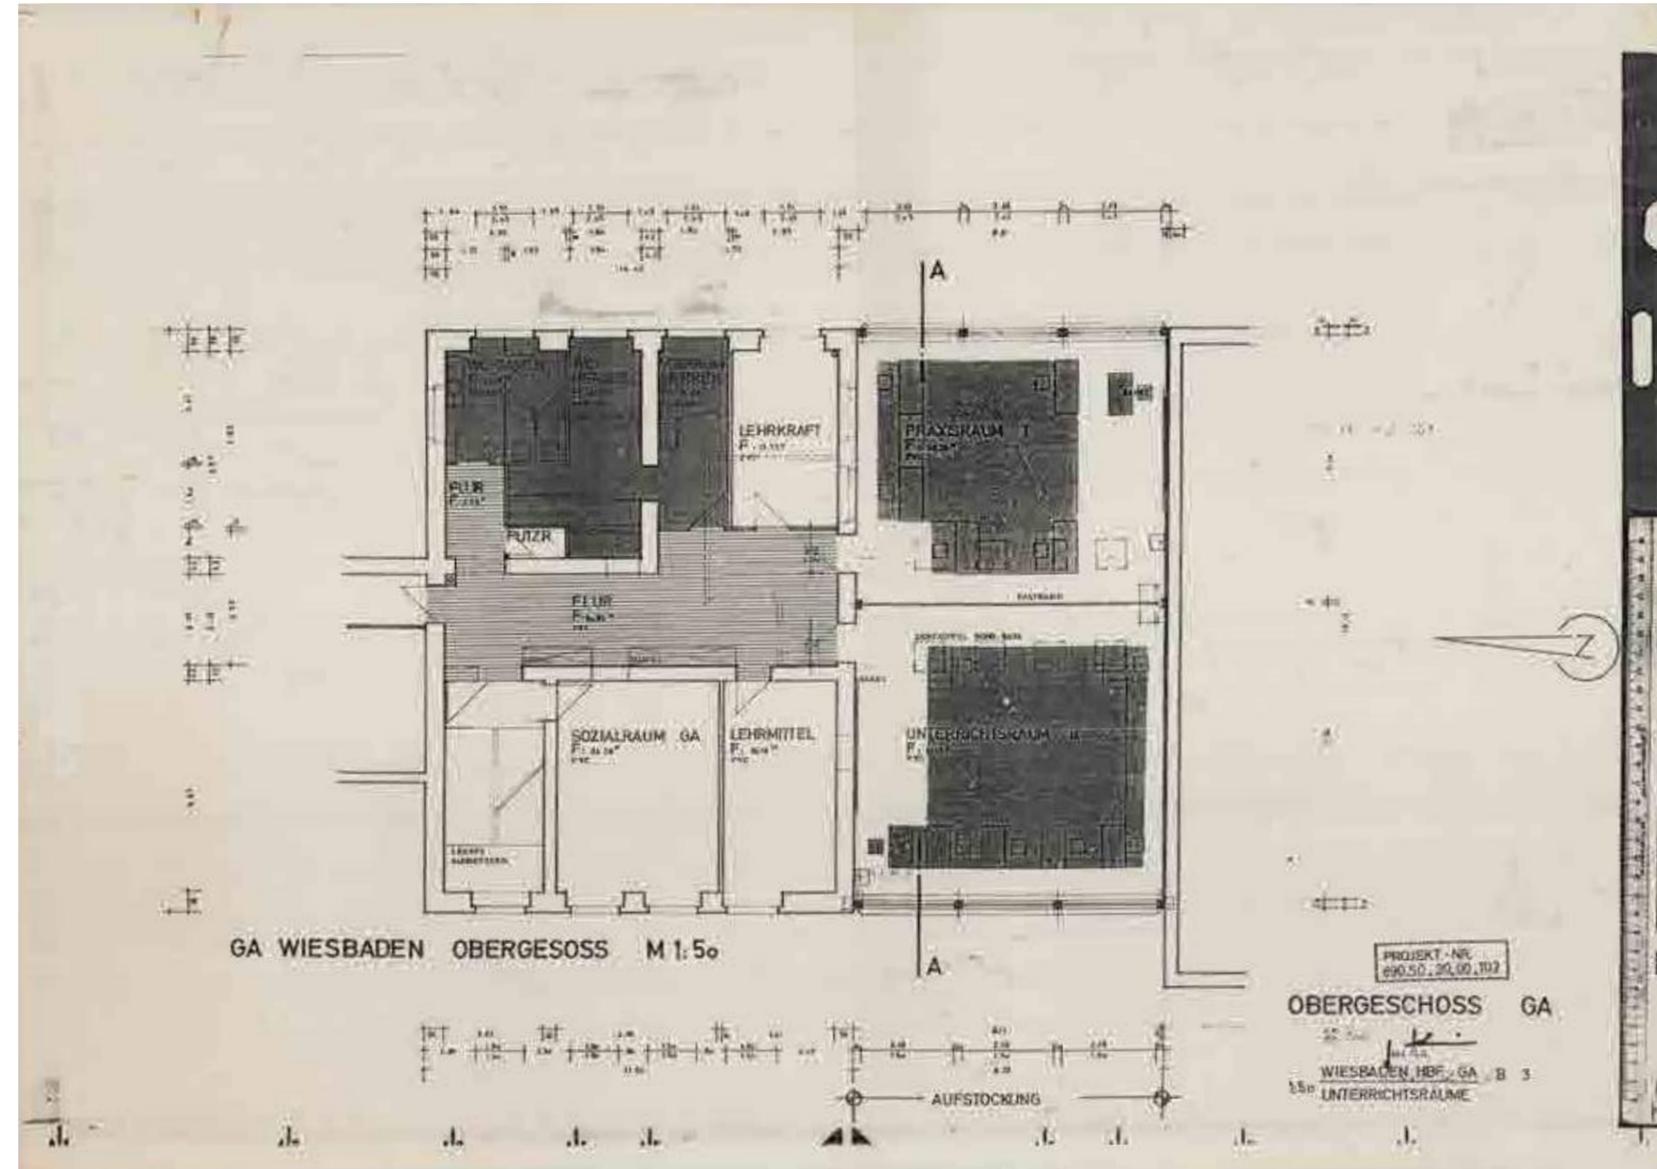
Güterabfertigung: Plan mit Grundriss des 1. Obergeschosses am Südende der Güterabfertigung, 1975
